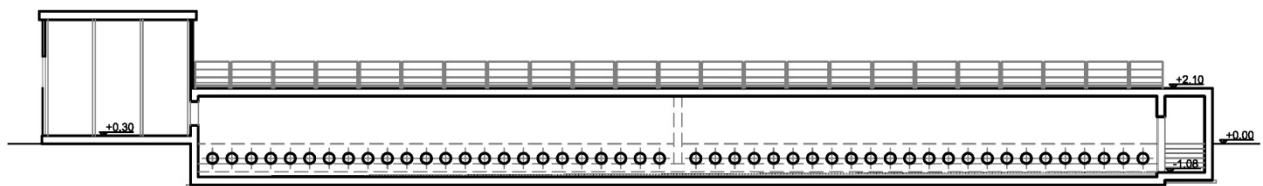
Sezione 2-2: Vista dall'interno del plenum verso i fori di insufflazione nelle celle biofiltranti
